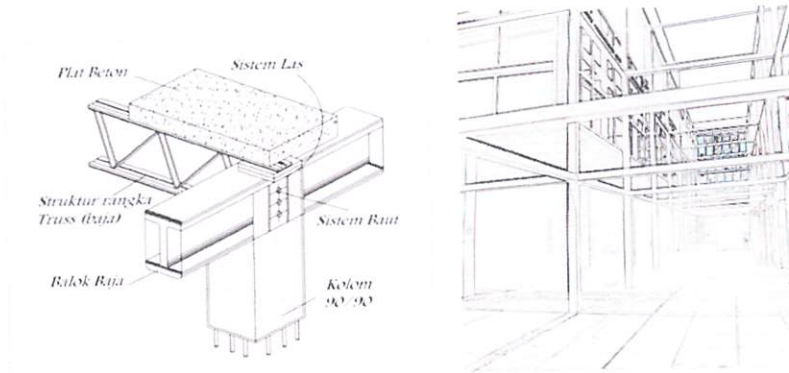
Bangunan dengan struktur rangka beton)
